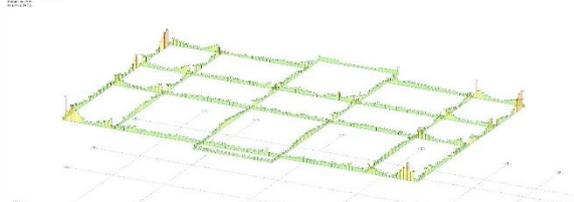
Расположение ригелей и максимальная площадь армирование на нижней грани ригелей с первого по пятые этажи пяти этажного каркасного железобетонного здания с внутренними и
